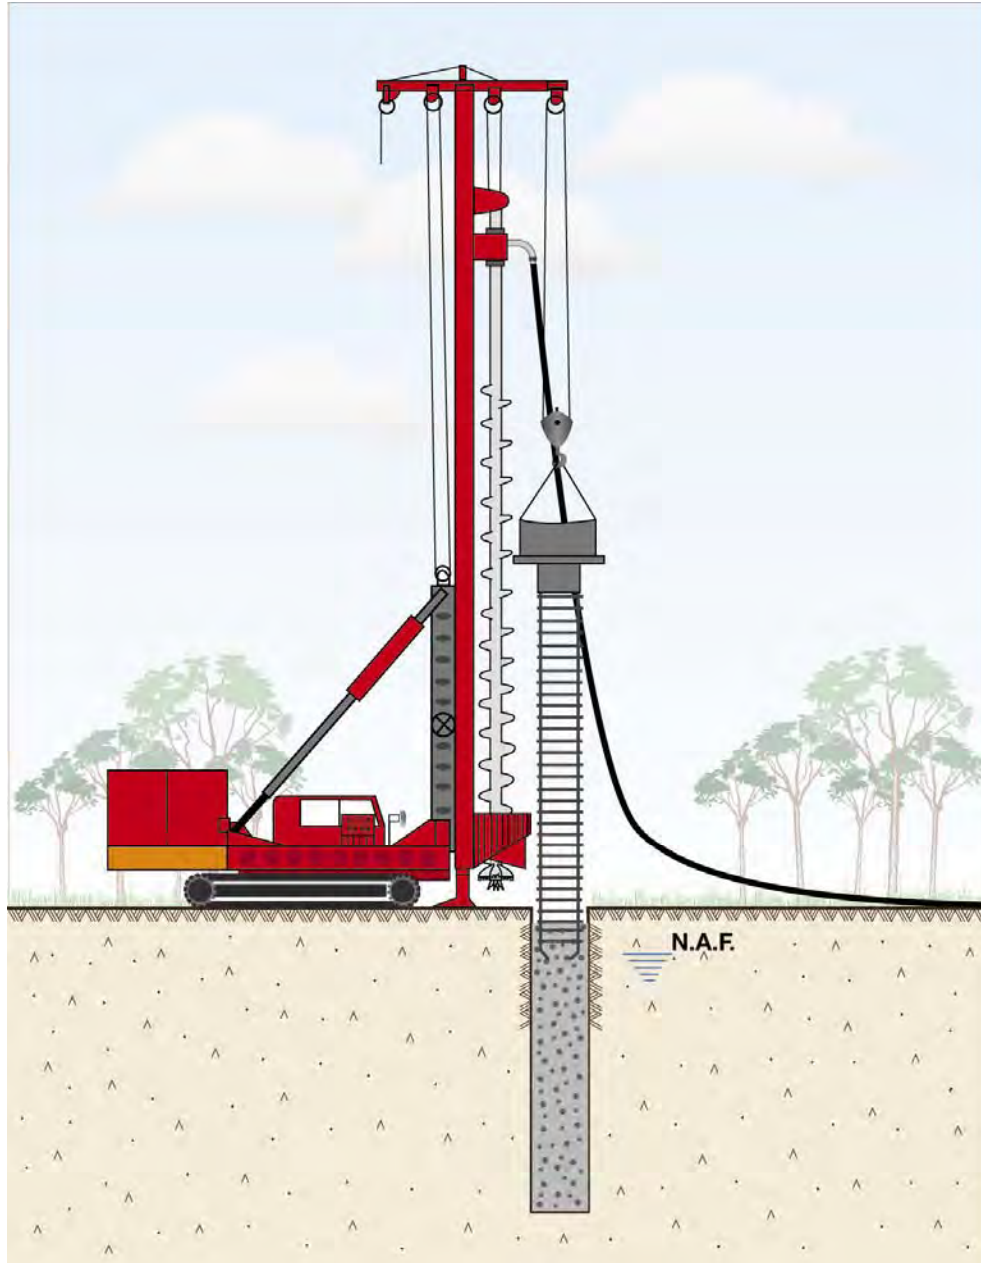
Introducción del acero de refuerzo en la pila colada
